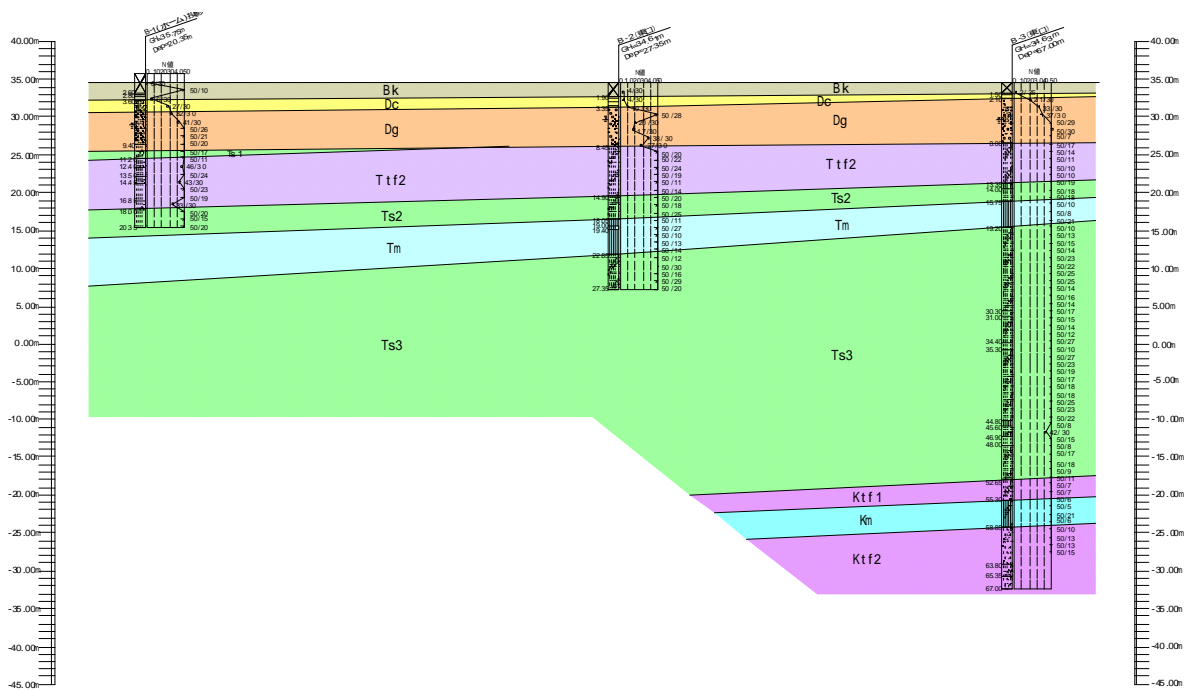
土層断面図 (B - B'断面) S=1:1000
